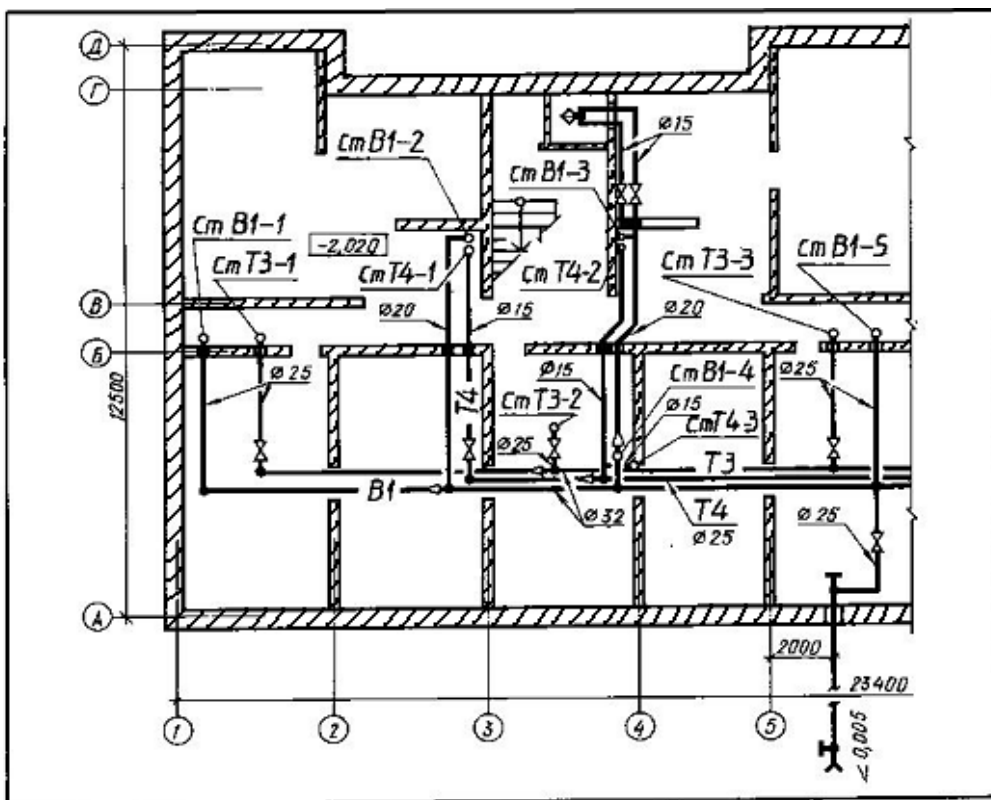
Графічне оформлення креслення плану системи водопроводу будинку
